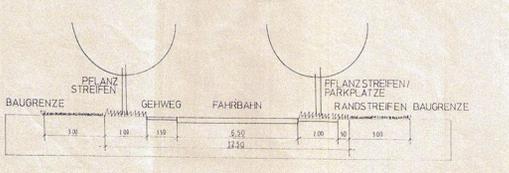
DETAIL VERKEHRSDÄMPFUNG G M: 1:200
